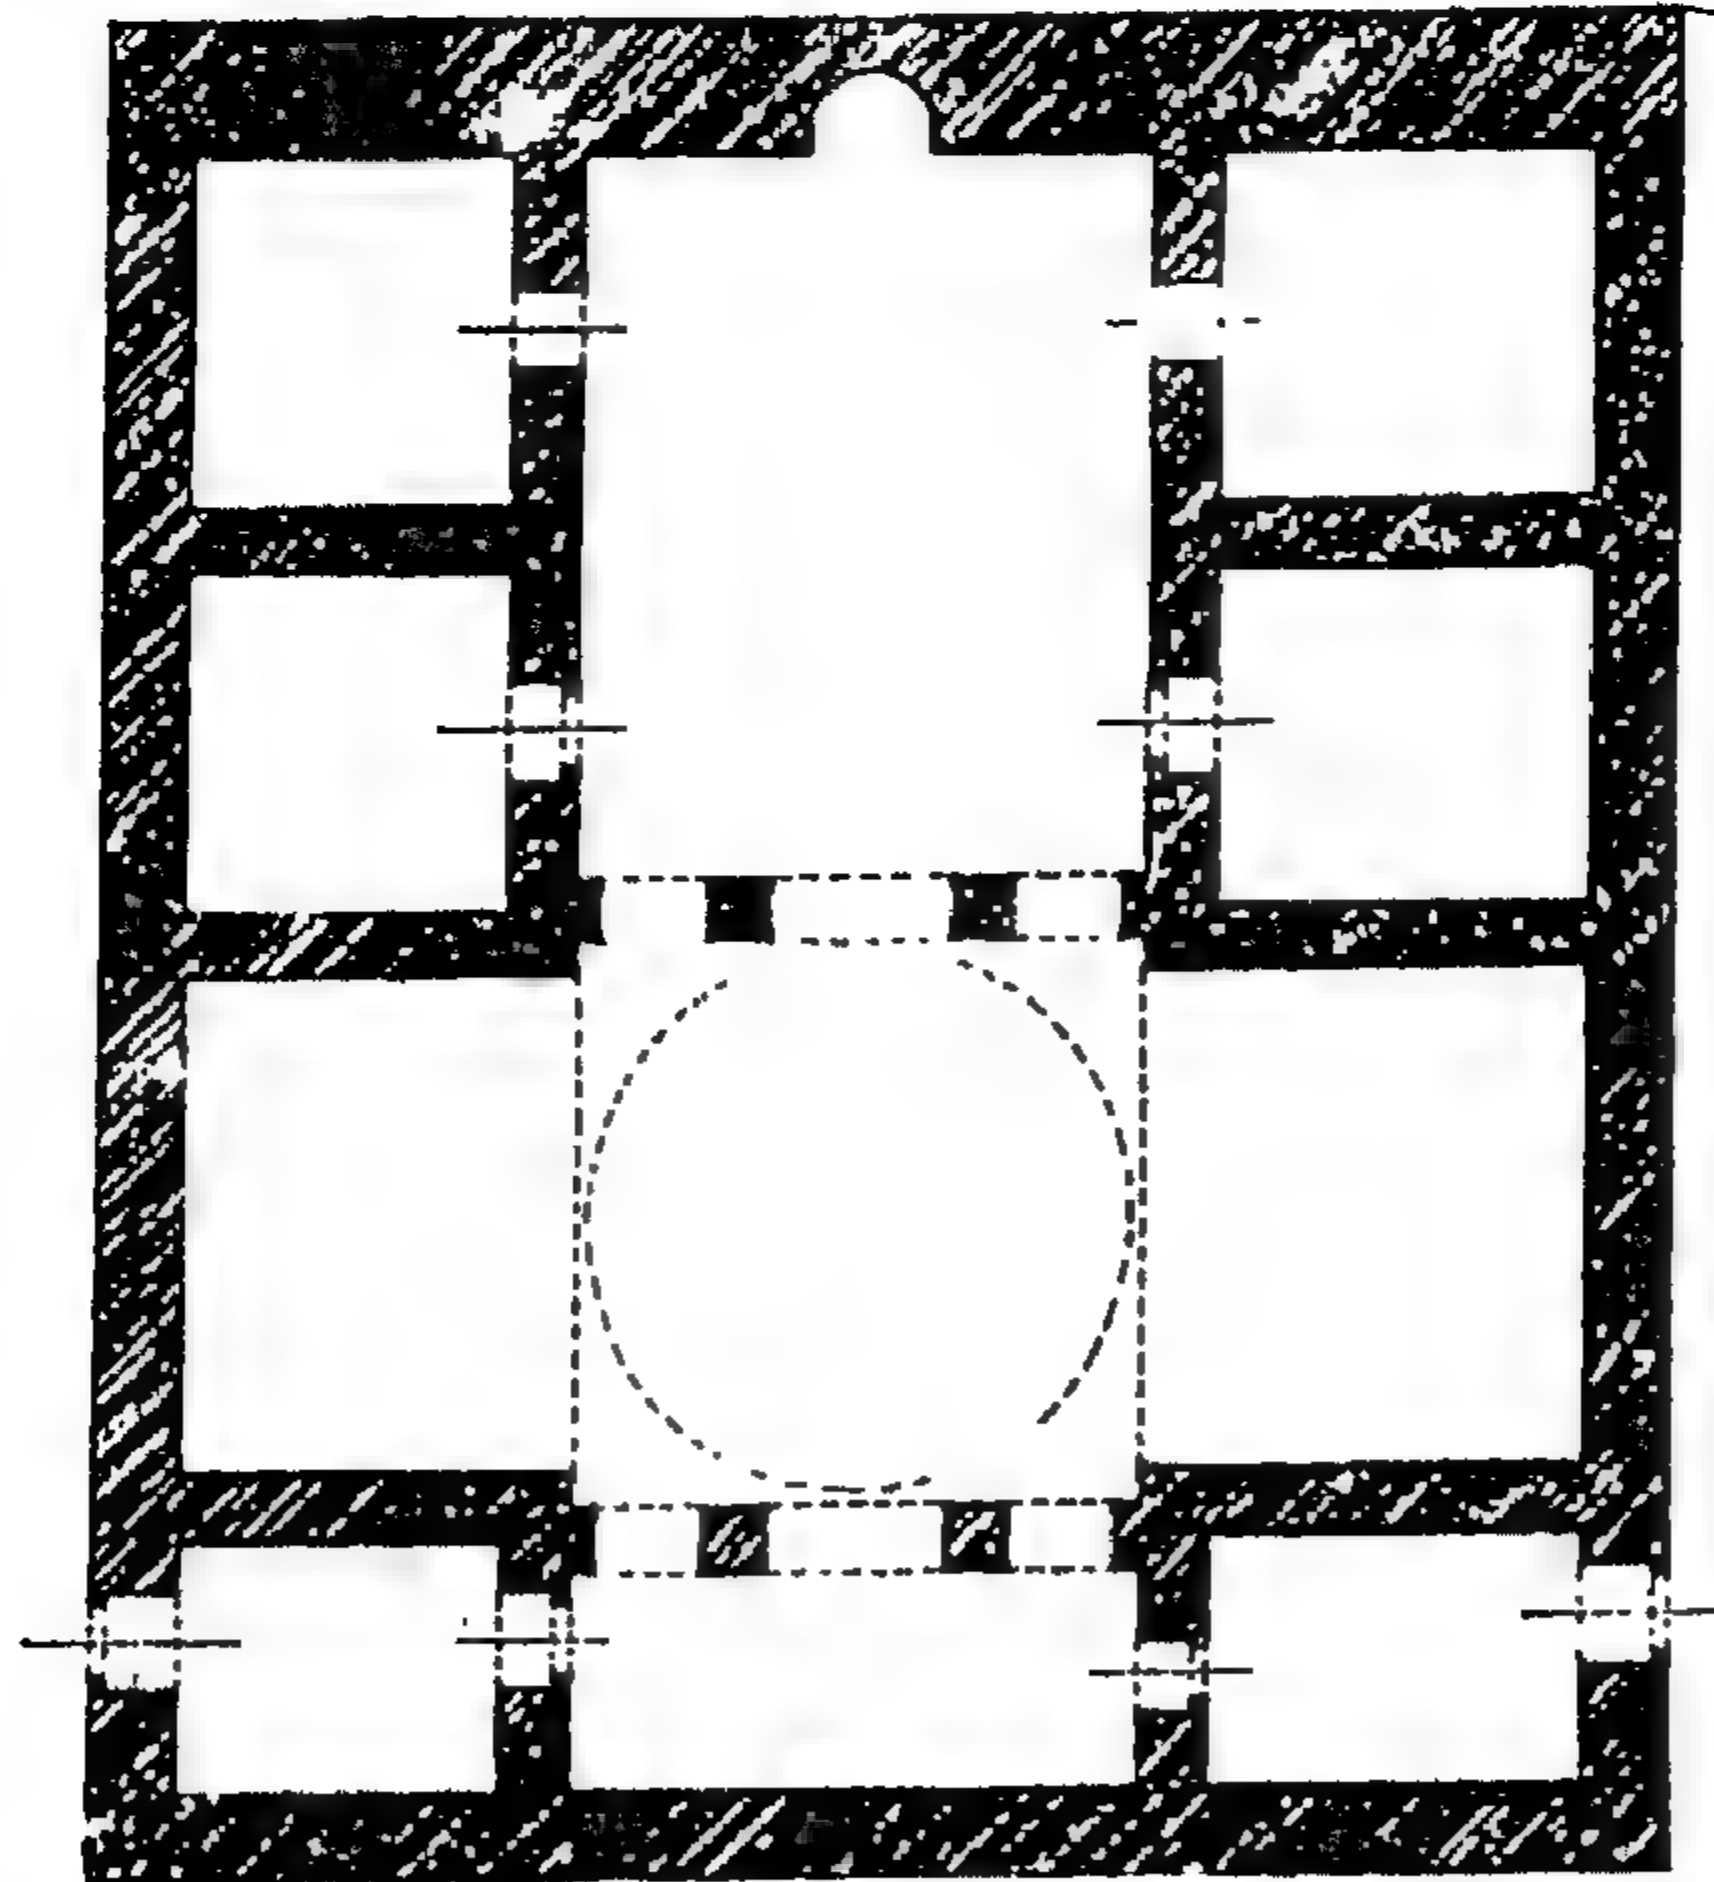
مسقط أفقي لجامع عثمان باشا (١) ضمن مجمعة بحلب
